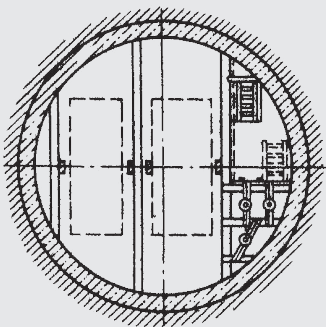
Поперечний розріз ствола, закріпленого бетоном
